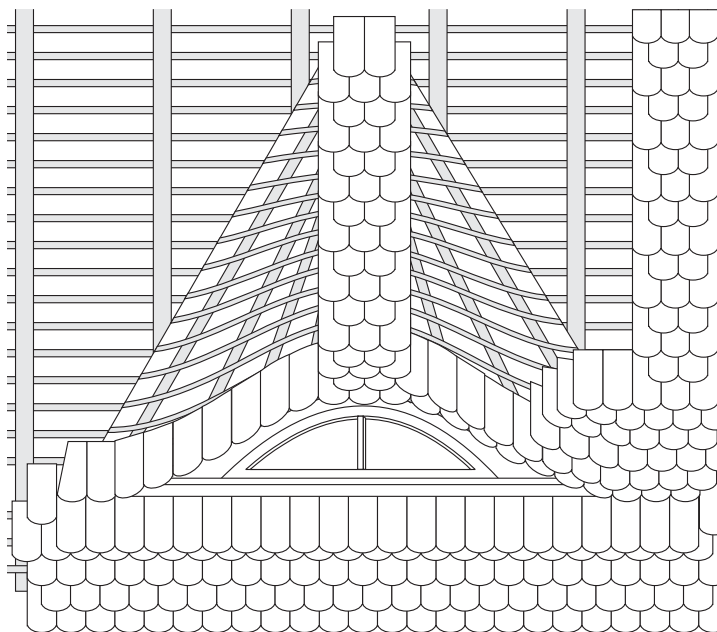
Konstrukcja łuku ściany szczytowej wolego oczka
